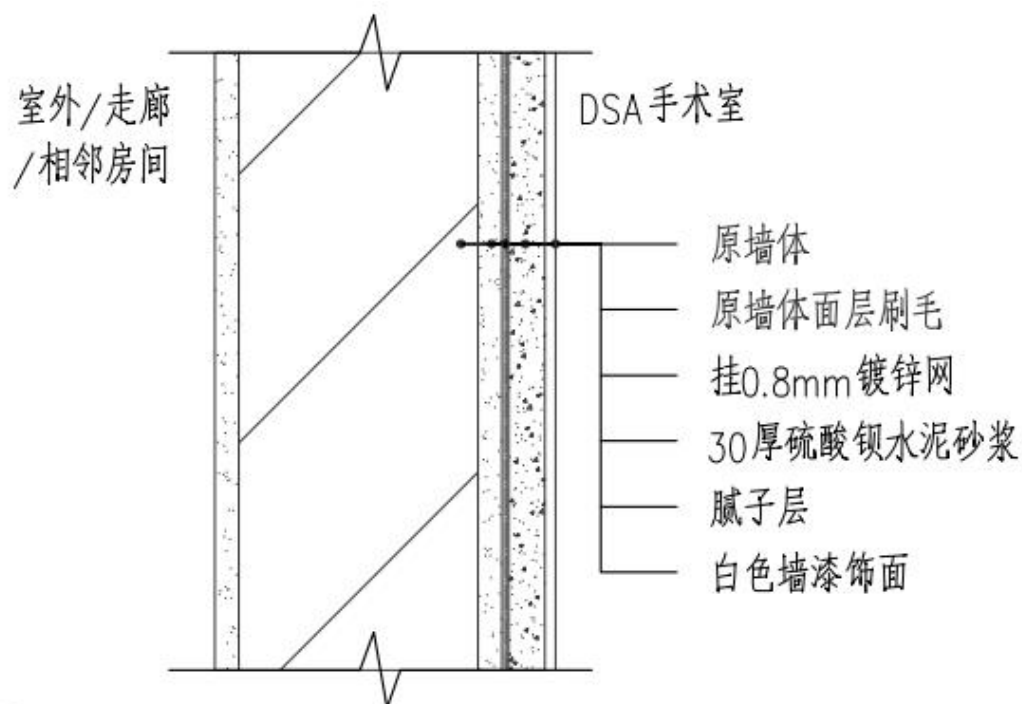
DSA 手术室原有墙体防护屏蔽材料及厚度示意图（剖面图）
